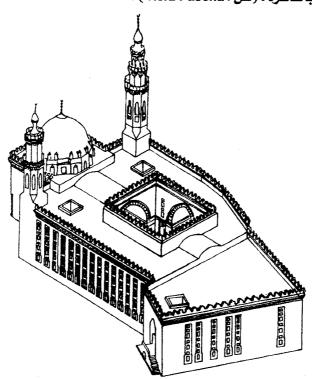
مسقط أفقي لمدرسة صرغمتش بالقاهرة (عن Kessler).
